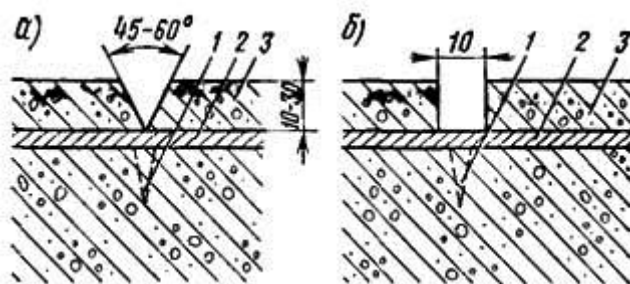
Схема разделки трещин: а – на клин; б – на прямоугольник; 1 – трещина; 2 – арматура; 3 – защитный слой бетона
